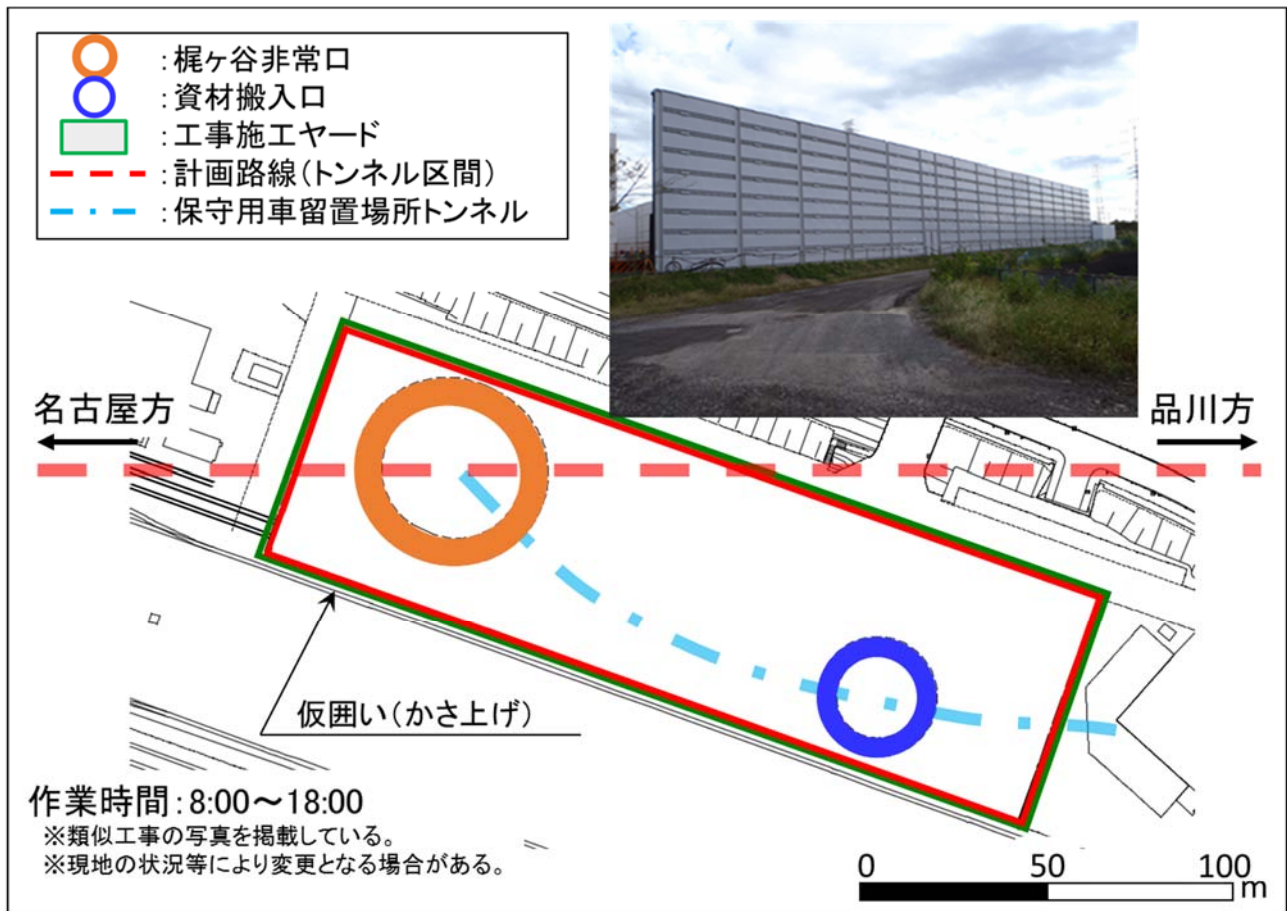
(3) 仮囲い設置（かさ上げ）の施工位置
